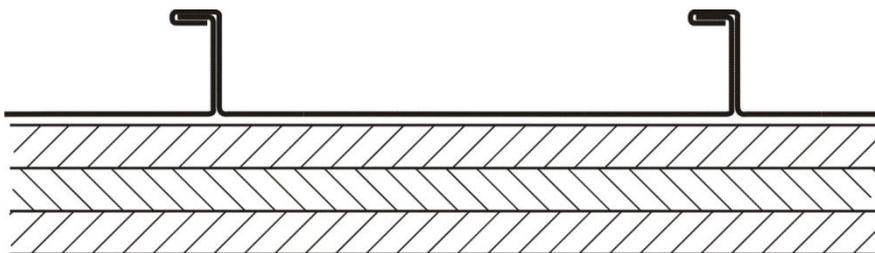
Coupe à travers un profilé de tôle posé, fixé sur un support.
